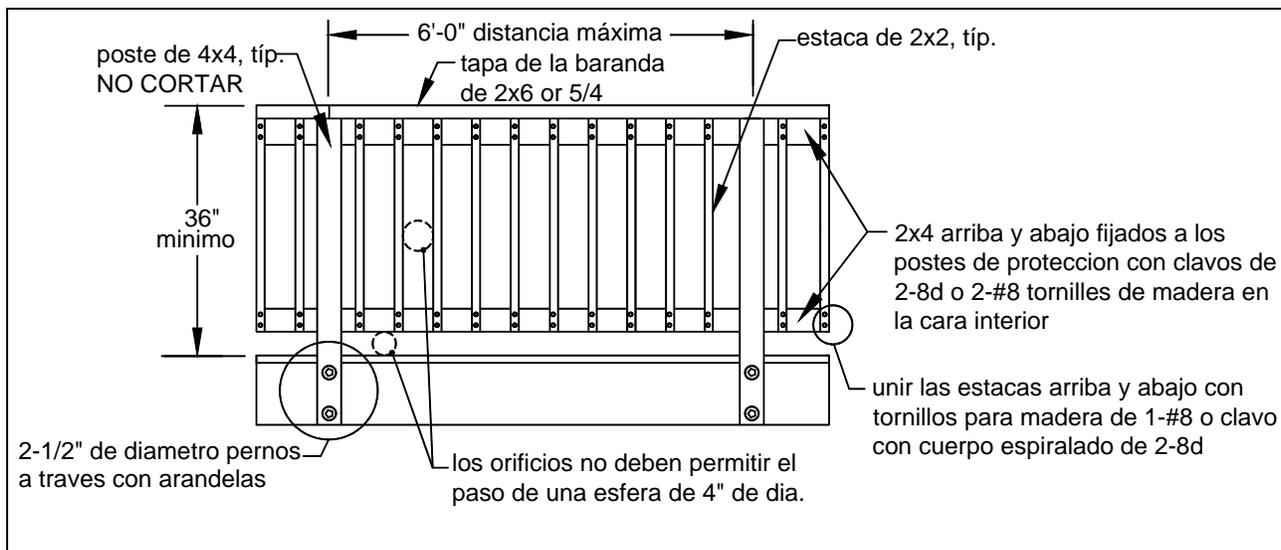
DETALLE TÍPICO SOBRE BARANDAS
